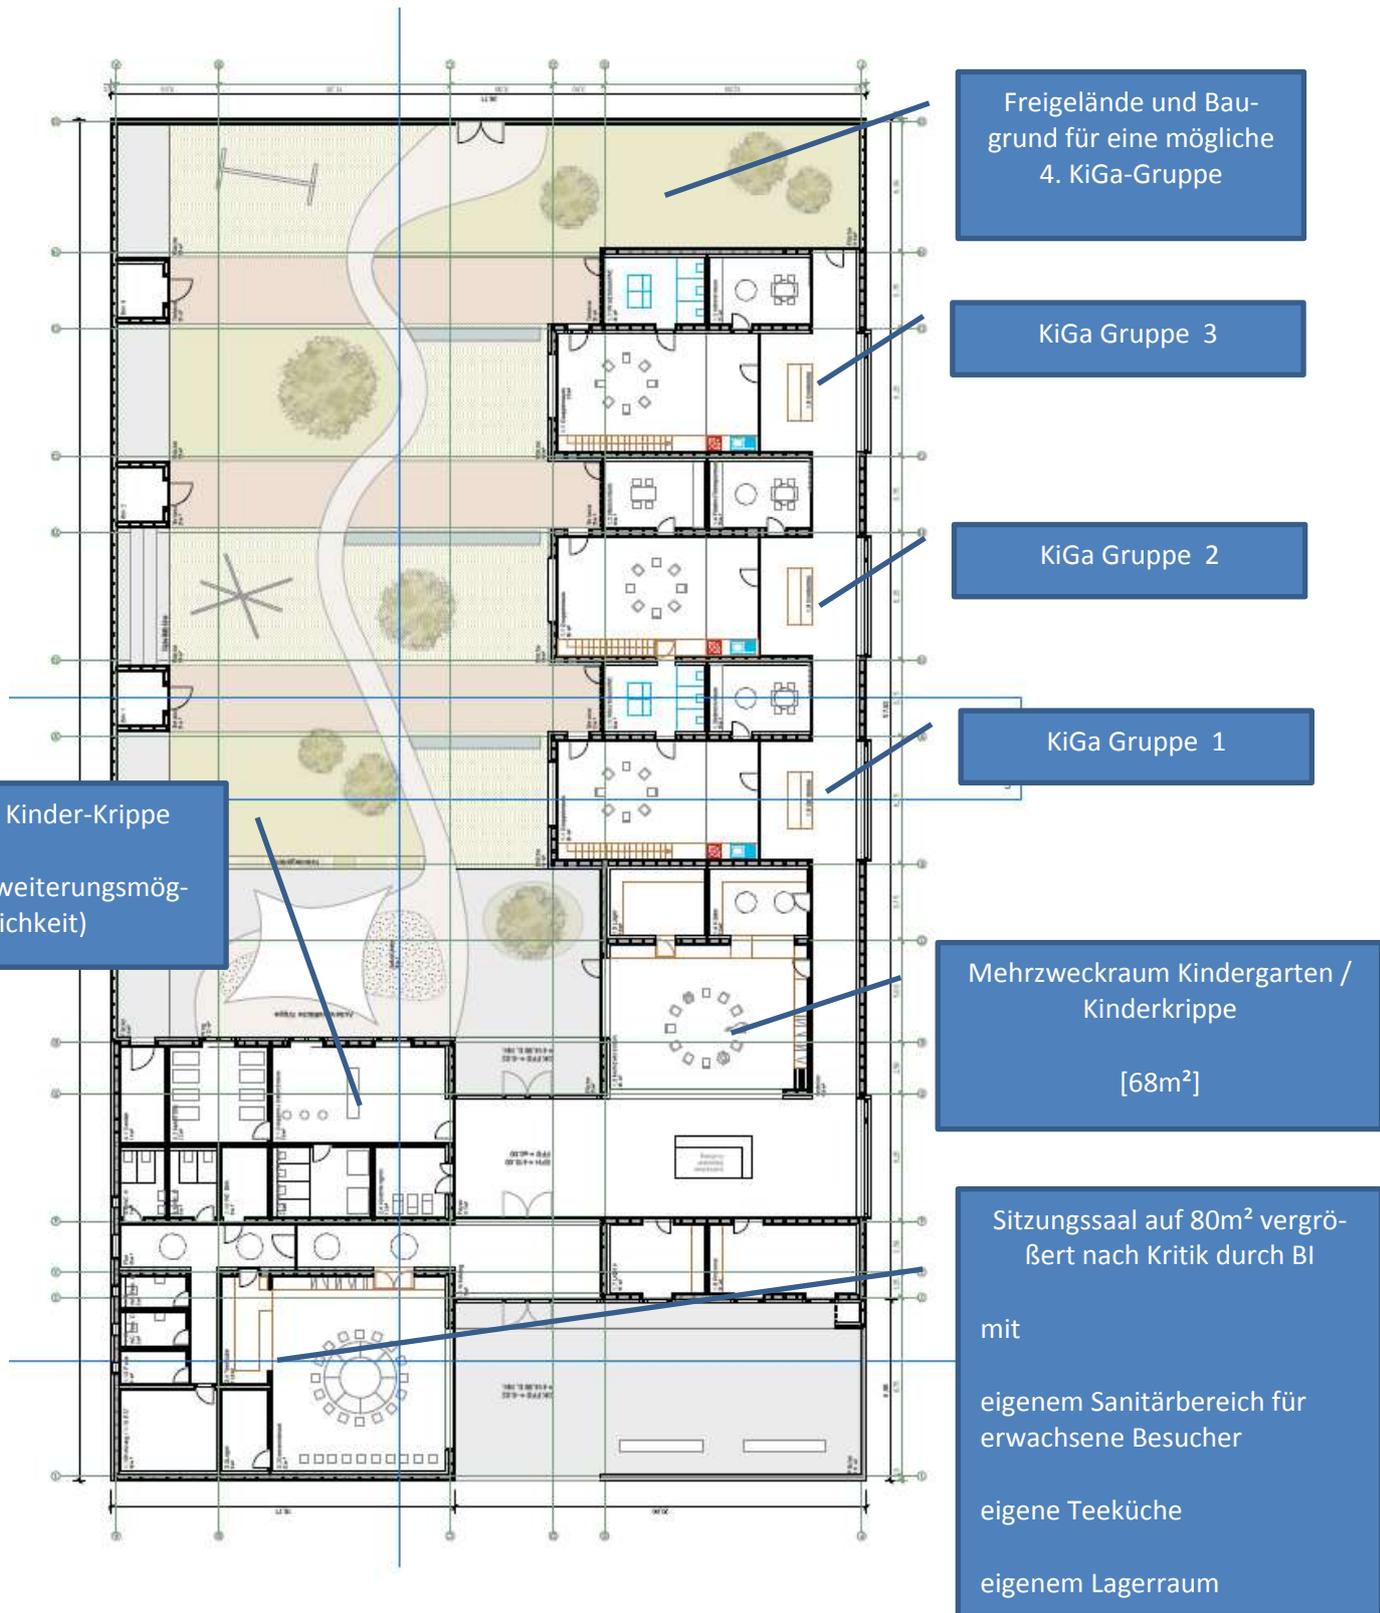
Grundriss KiGa-KiKri-Sitzungssaal nach nach Änderungen im September 2018
